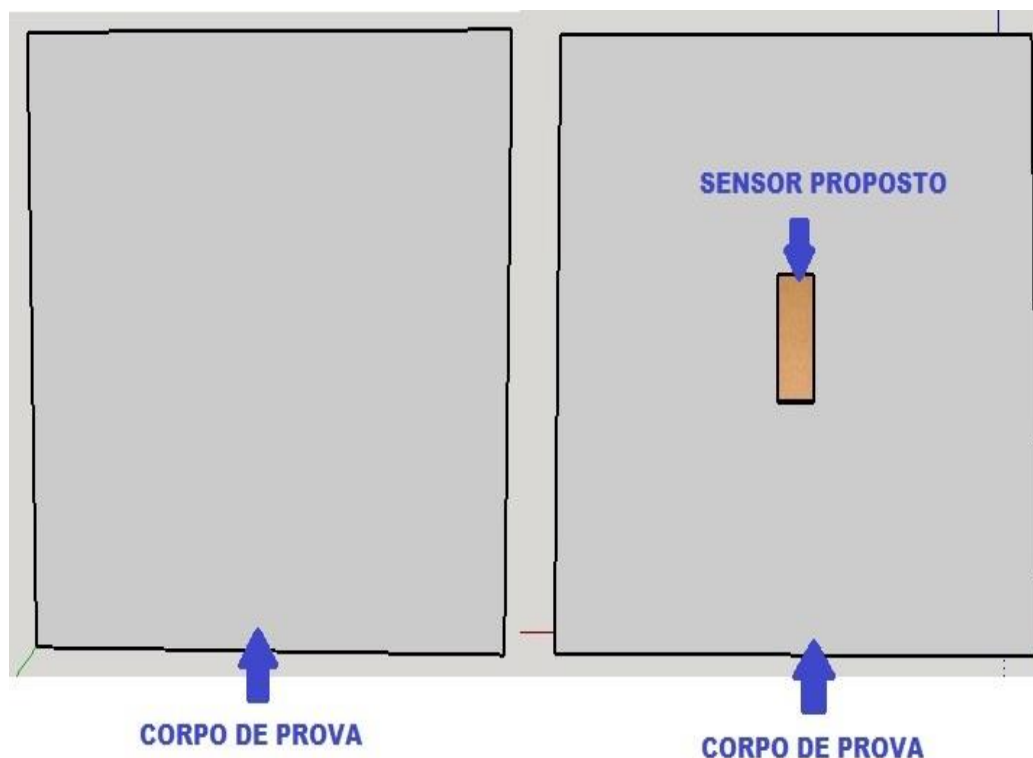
Modelagem em 3D do corpo de prova de concreto.
